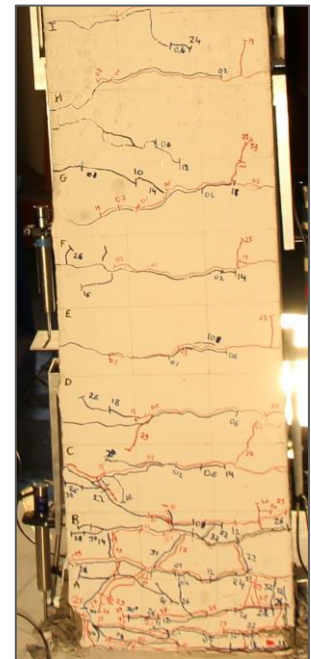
Fissuration horizontale de la colonne C1A au LS33
